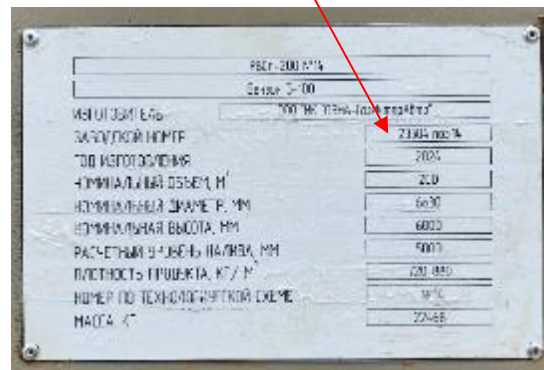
Маркировочная табличка резервуара РВСП-200, заводской номер 23304 поз.14
